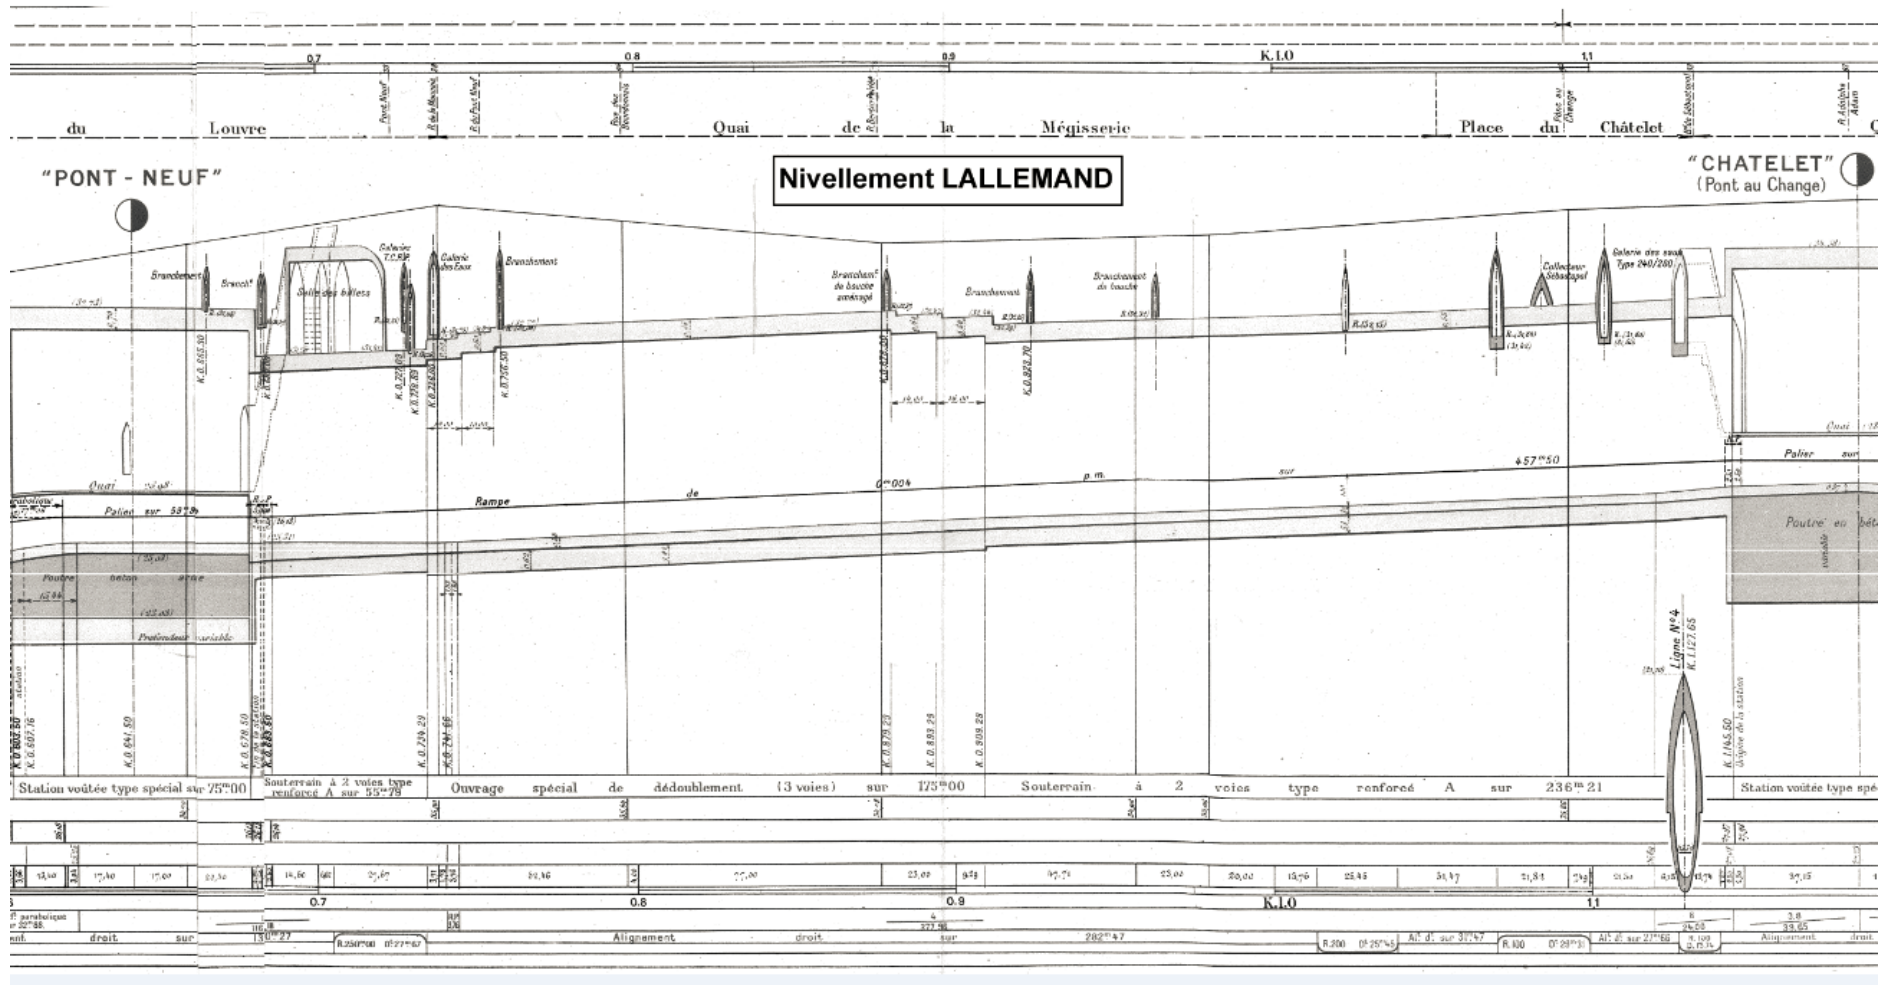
Profil du tronçon du tunnel entre la station châtelet à Pont Neuf.
